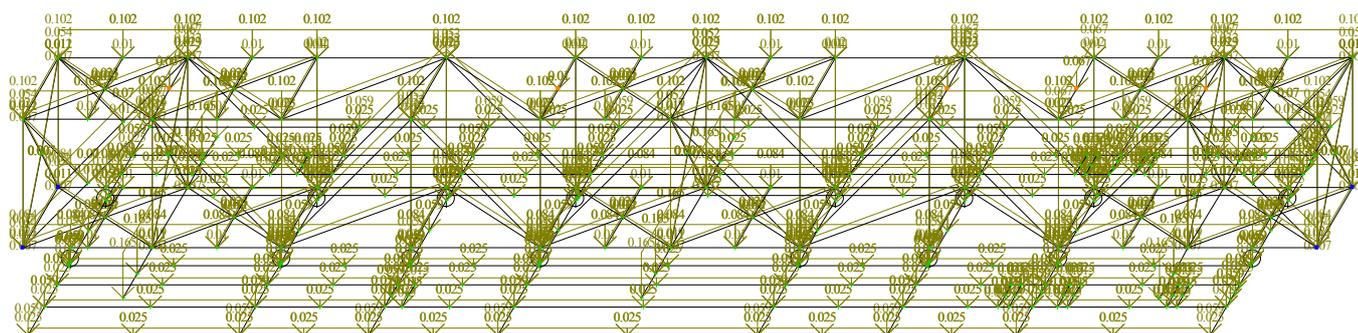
Вертикальные нагрузки от собственного веса конструкций ферм
